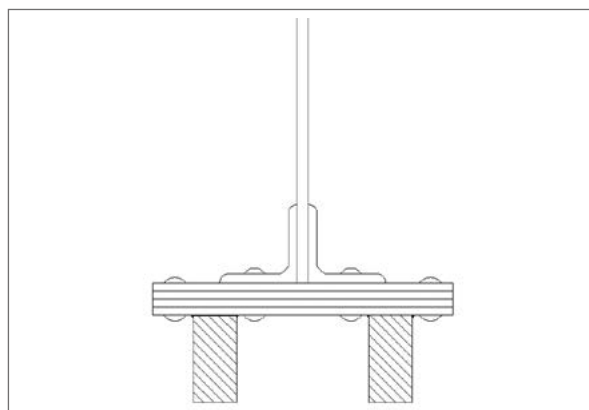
Principe de renforcement par ajout de profilés métalliques soudés
